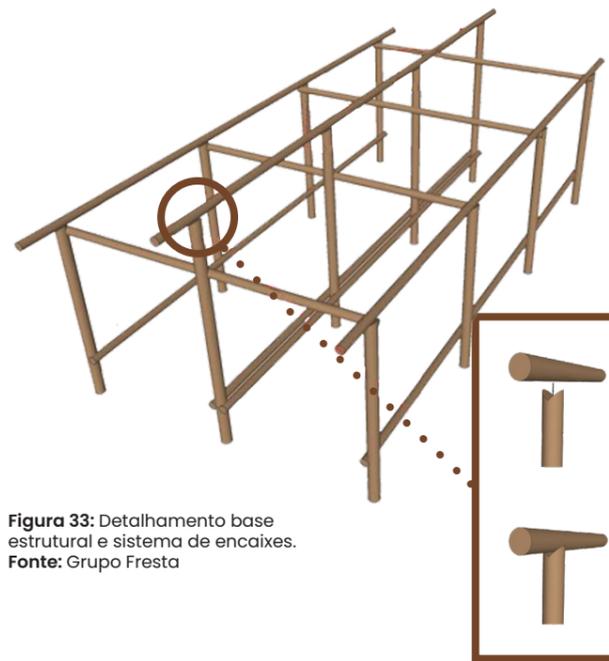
Detalhamento base estrutural e sistema de encaixes.
